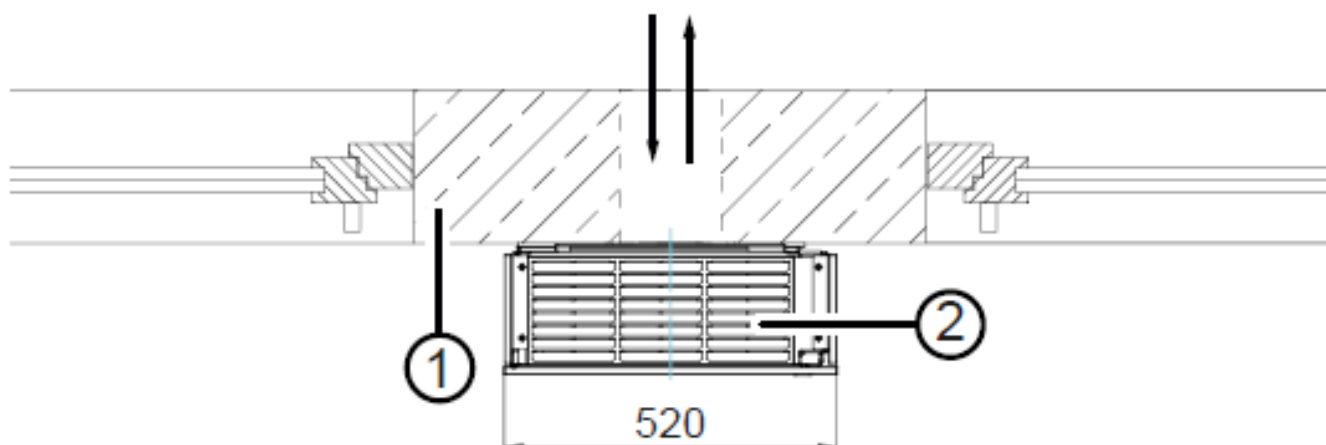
větrací přístroj X-Flow – varianta instalace A vlevo (pohled shora).
